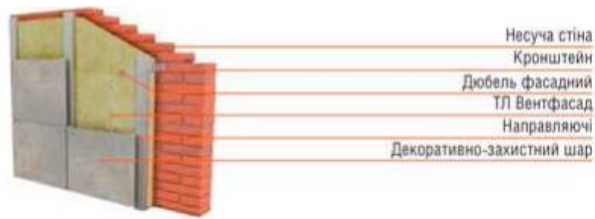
Вентильований фасад від ТМ «Термолайф»
